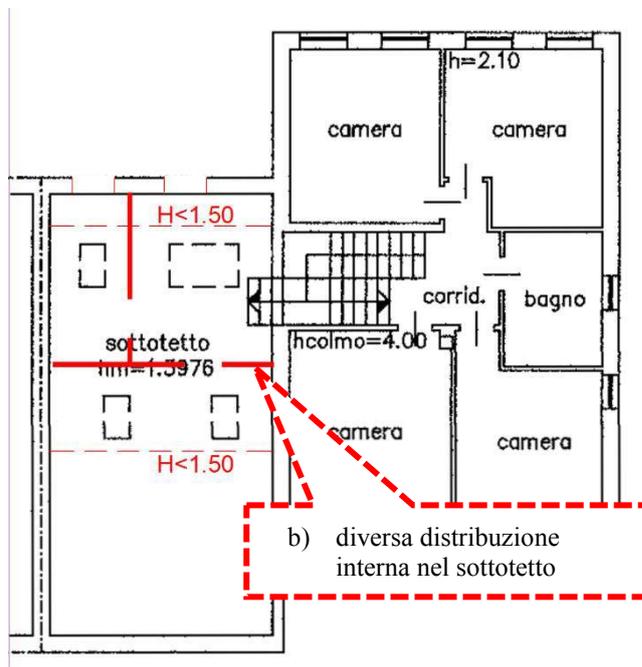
Estratto planimetria catastale del piano primo con indicazione delle difformità
